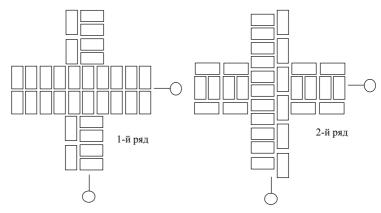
Кладка пересечений стен толщиной в 2 и 1,5 кирпича
